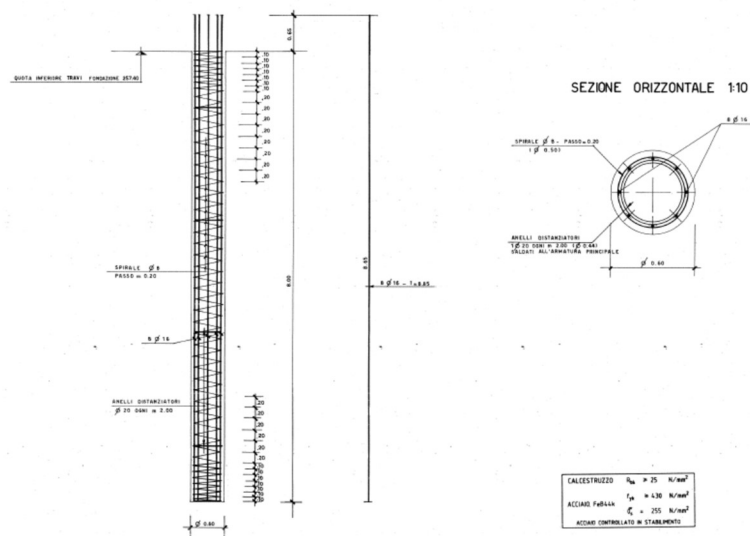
Progetto di esecutivo del 1985 – Sezioni del palo di fondazione tipo
